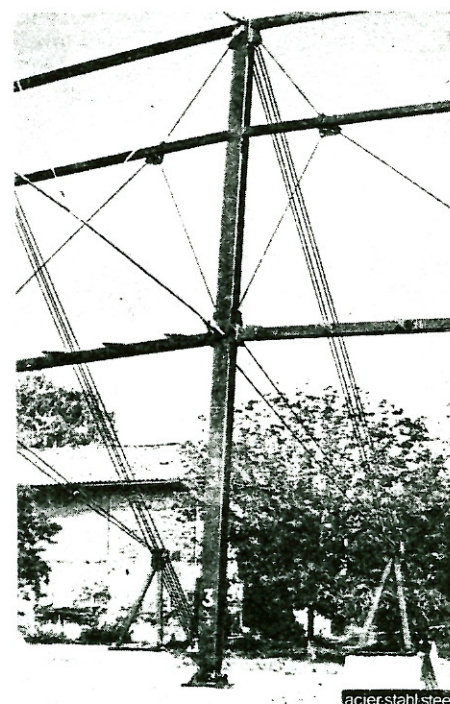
Dettaglio di un pilastro centrale e suo ancoraggio al cavalletto.
